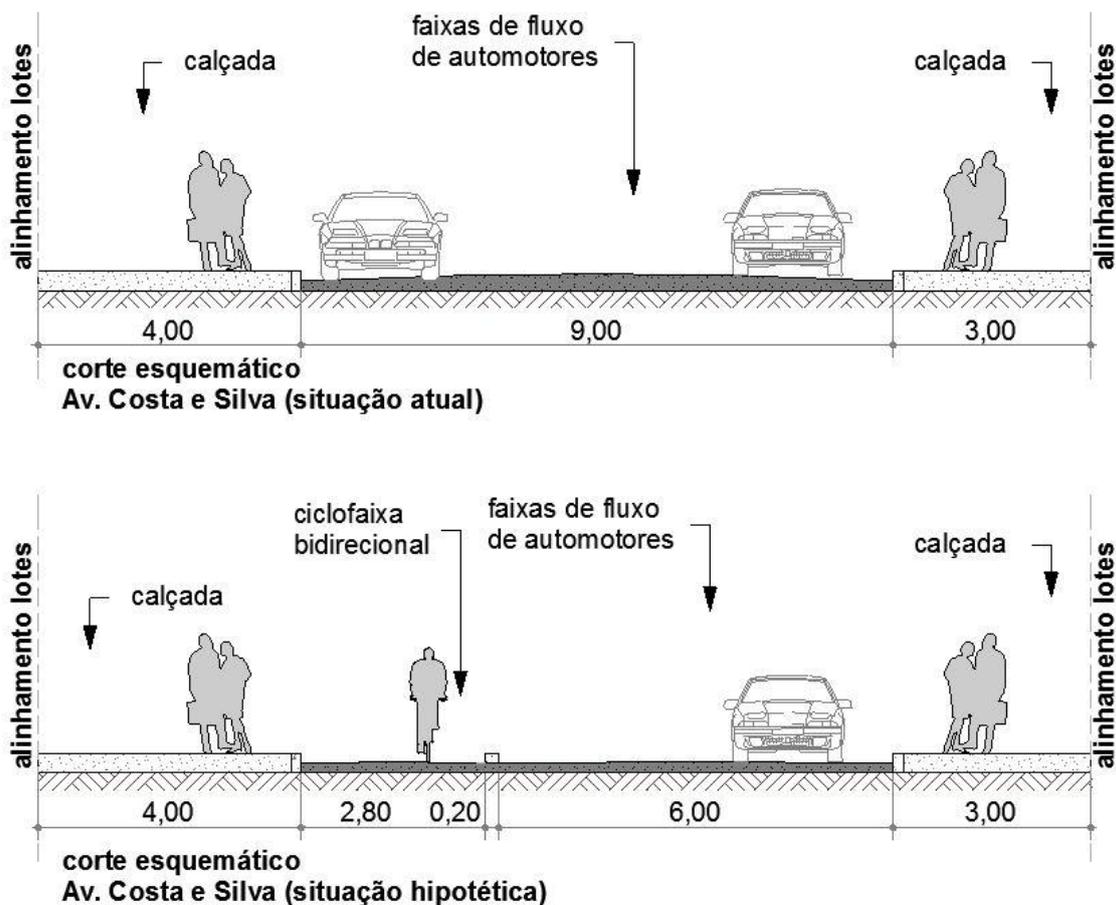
Corte esquemático Av. Costa e Silva, (fonte: autor)
